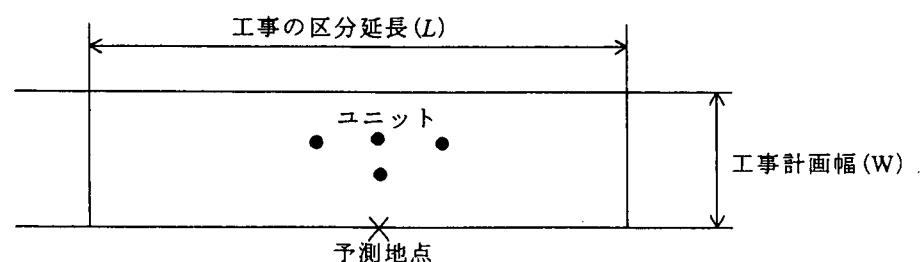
施工範囲が特定される場合の施工範囲とユニットの配置例
